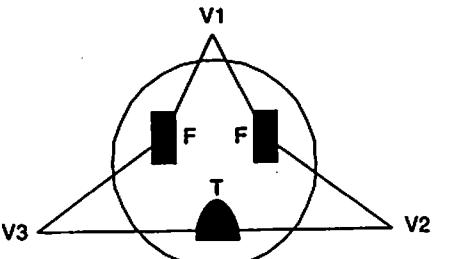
Instalação correta da ligação FASE, FASE e TERRA.
